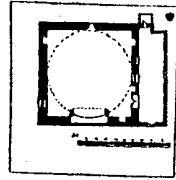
مكرر) مسقط أفقى لمسجد
